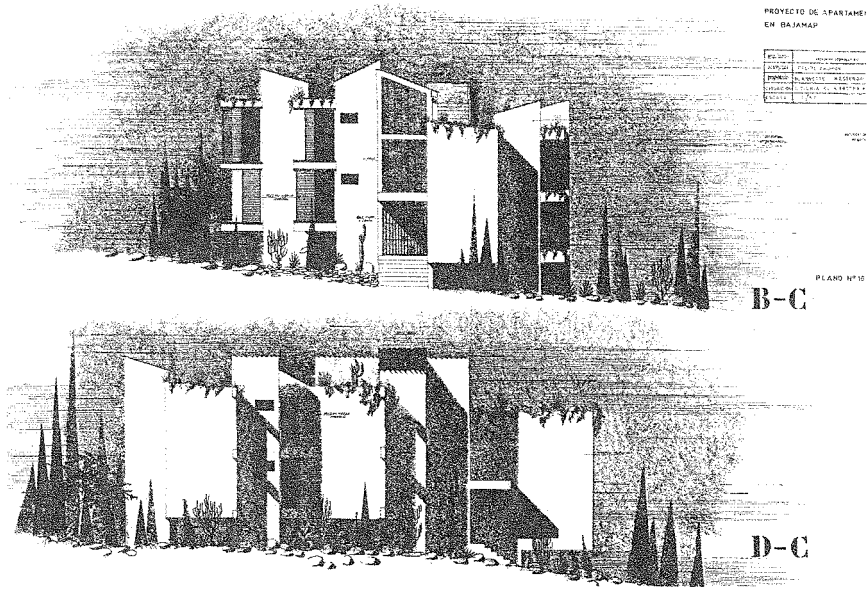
S. Fábregas, Plano n.º 10. Alzado de fachadas. Proyecto de apartamentos en Bajamar, Tenerife, 1963 (Archivo Fábregas).
